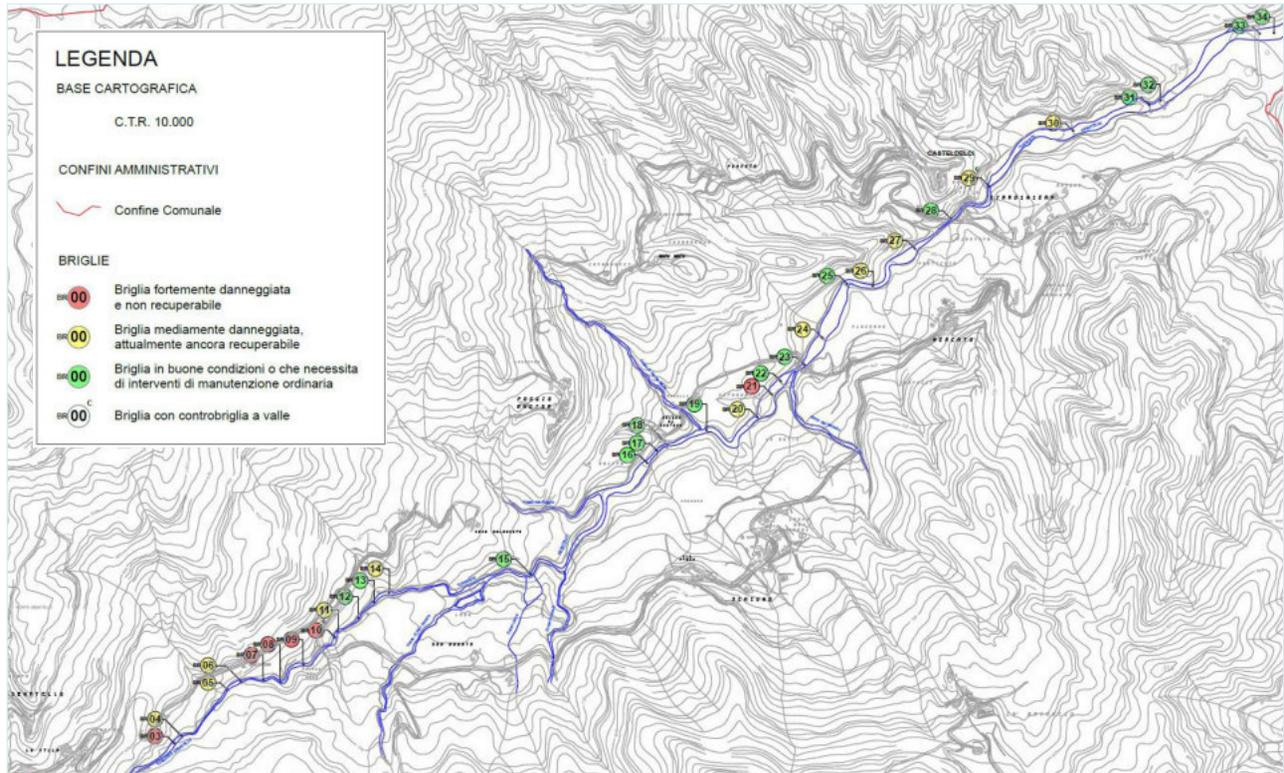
Planimetria torrente Senatello con individuazione briglie
